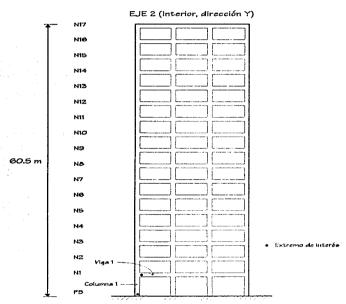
Miembros cetructurales y extremos de interés del eje 2, cetructuras de 17 niveles discñadas en las zonas il y ili
